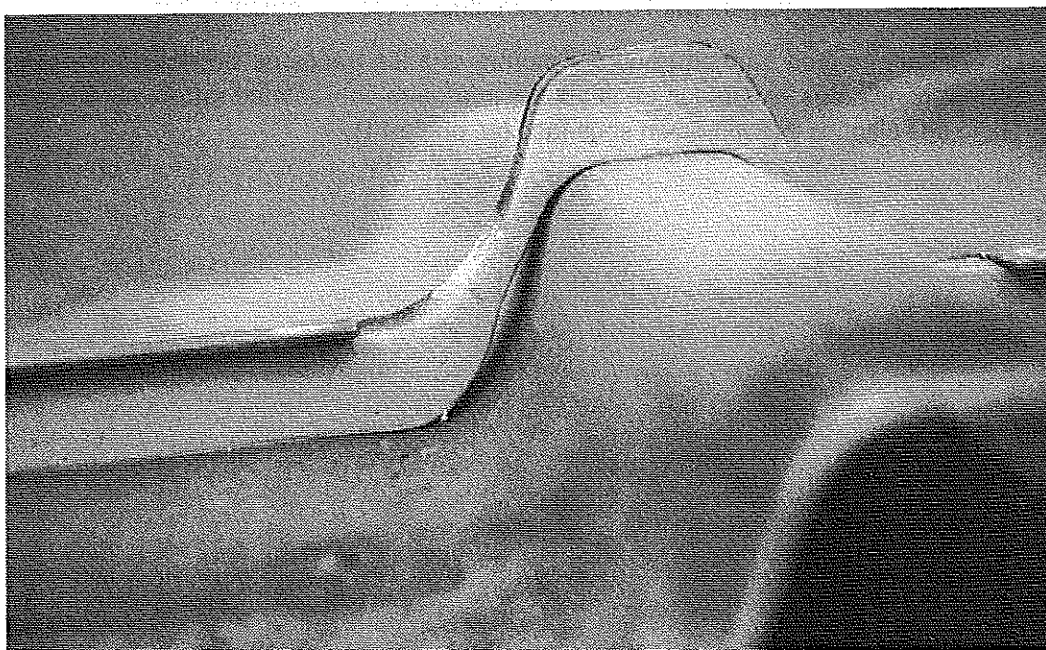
Détail du joint entre plaques (mousse de polyéthylène comprimée fissurée). Étanchéité à l'air non assurée. © J. Putatti
